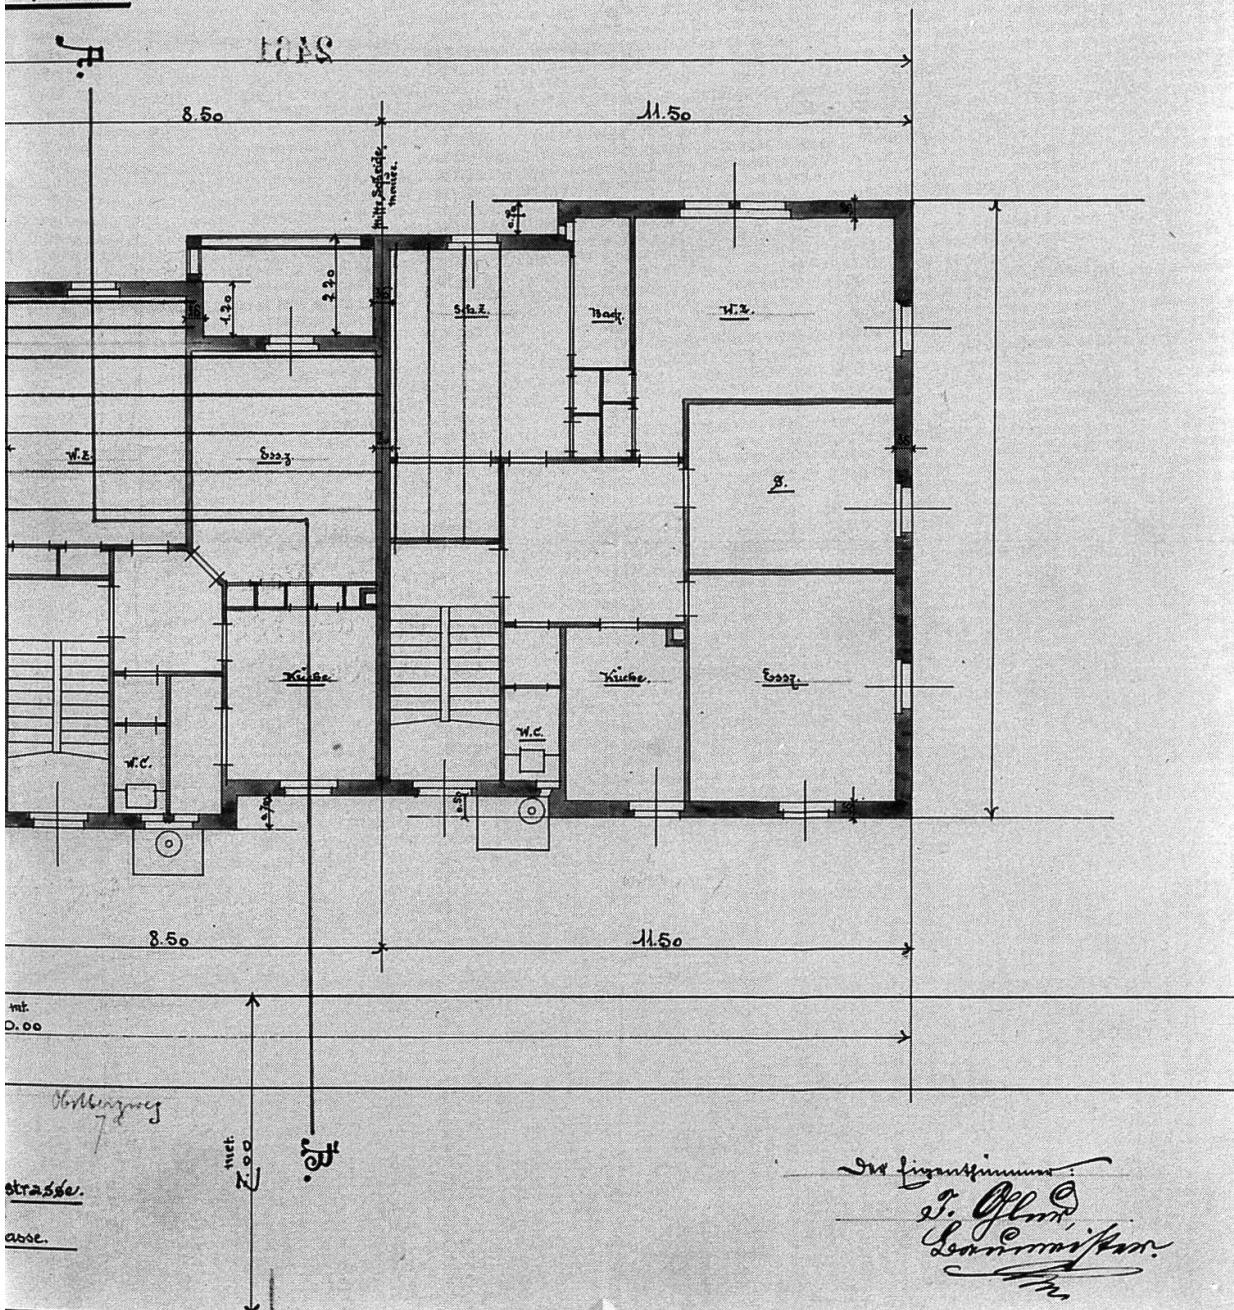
Obstbergweg 5-9. Grundriss von 1892.
